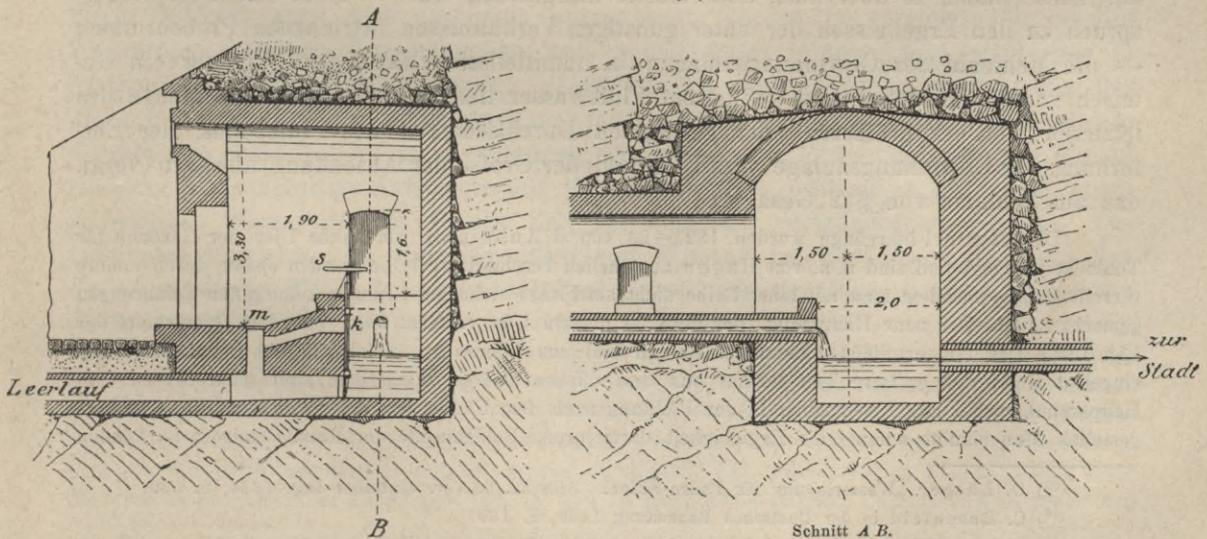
Sammelstube der Quellwasserleitung für Baden-Baden. M. 1:125.
